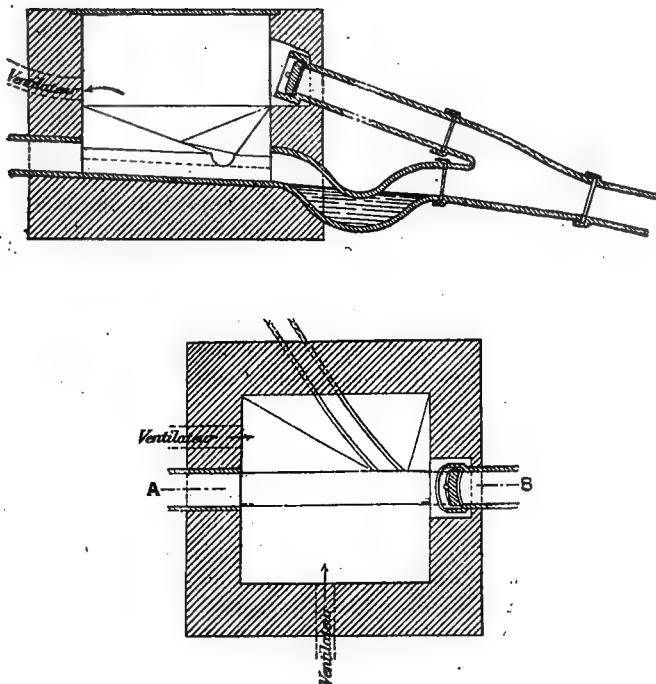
Maison salubre : regard de visite, plan et élévation (100).
